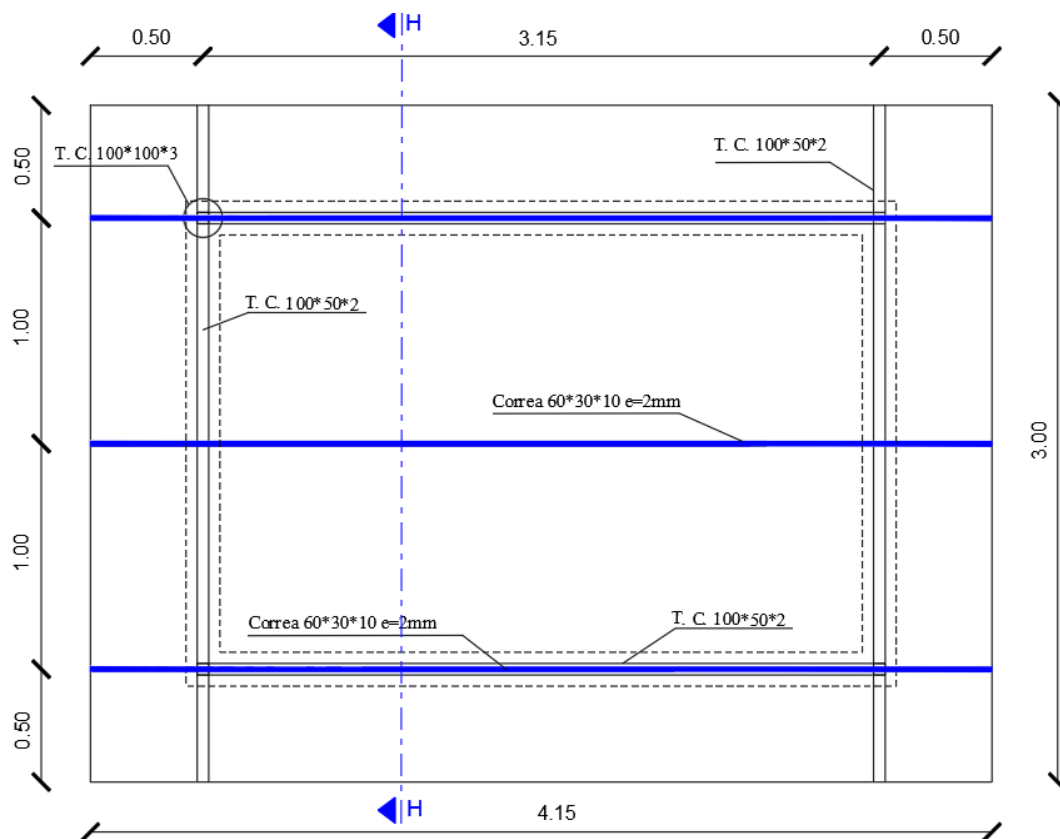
Vista en planta de la cubierta del lecho de secado de lodos rediseñado.
